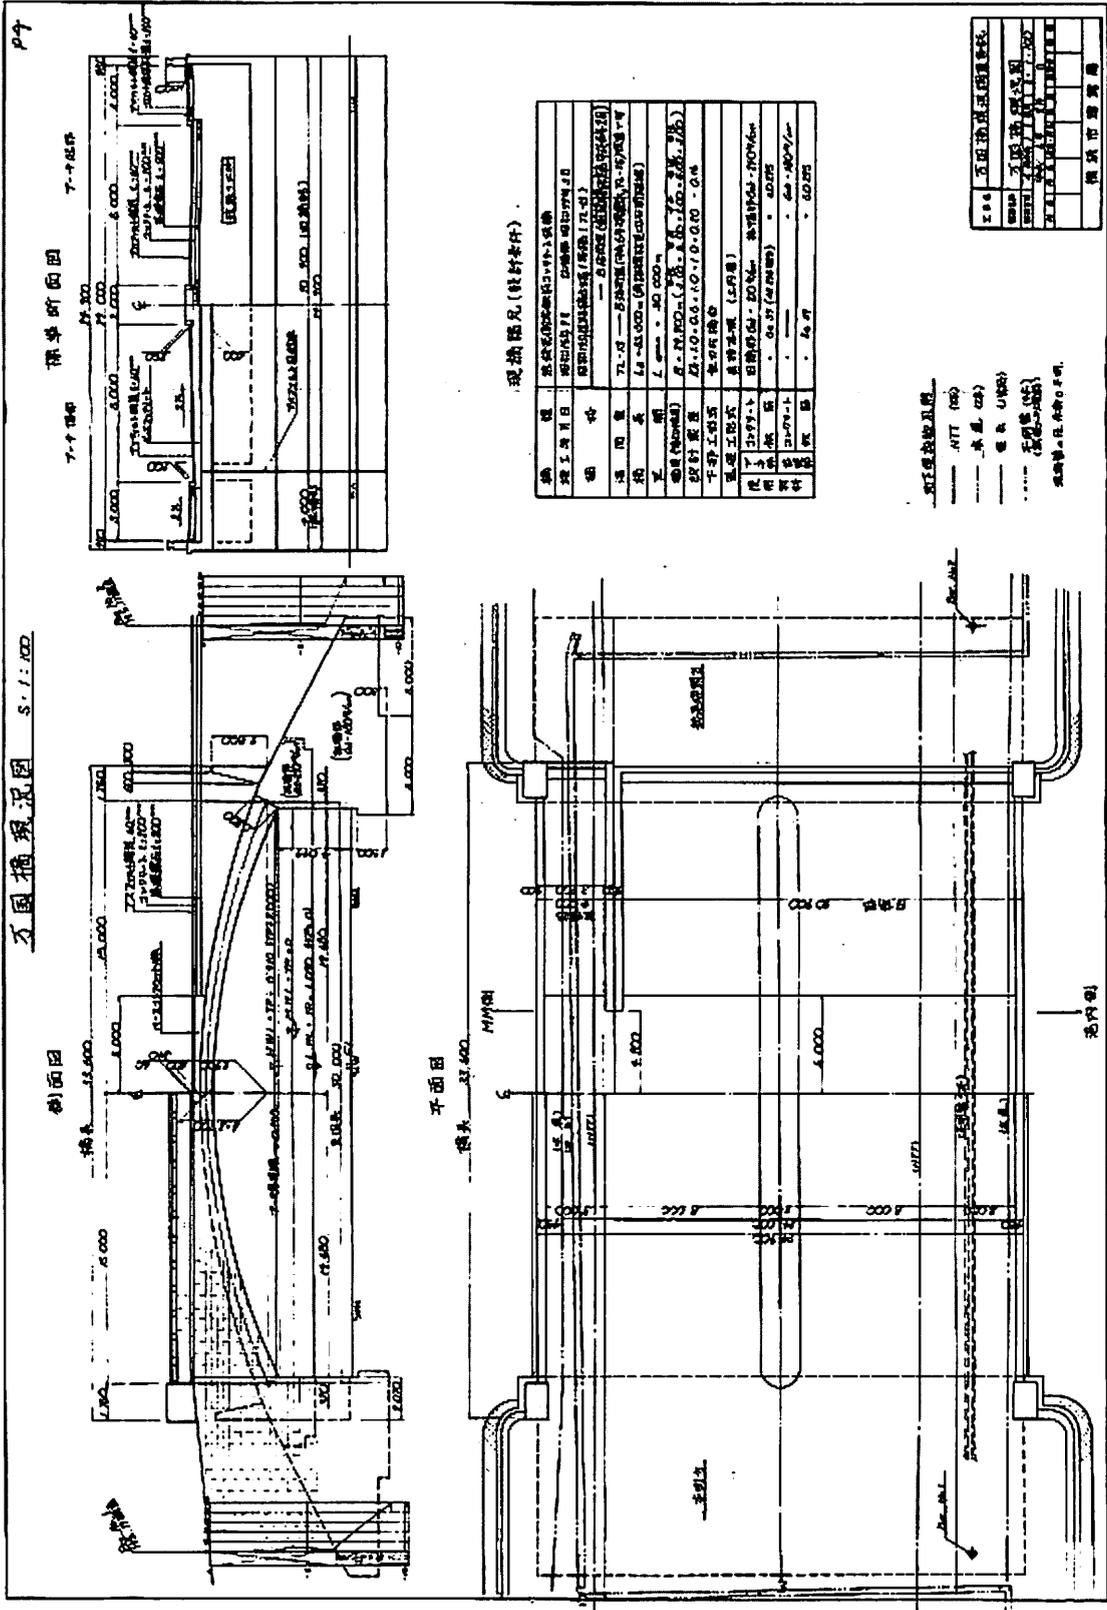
昭和49年改修後の万国橋の平面、立面、断面図(現況)
